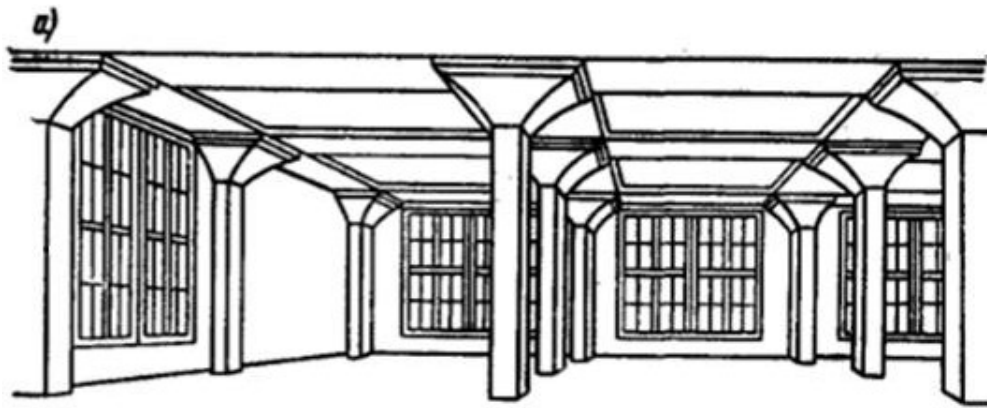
Конструкция безбалочного сборного перекрытия с ребристыми панелями
